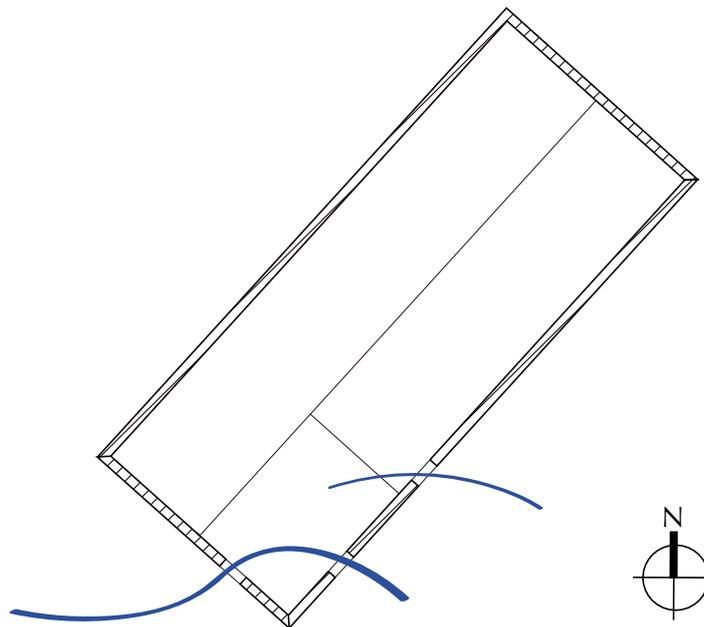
Esquema de ventilación en Bryggen. Fuente: Elaboración propia.
